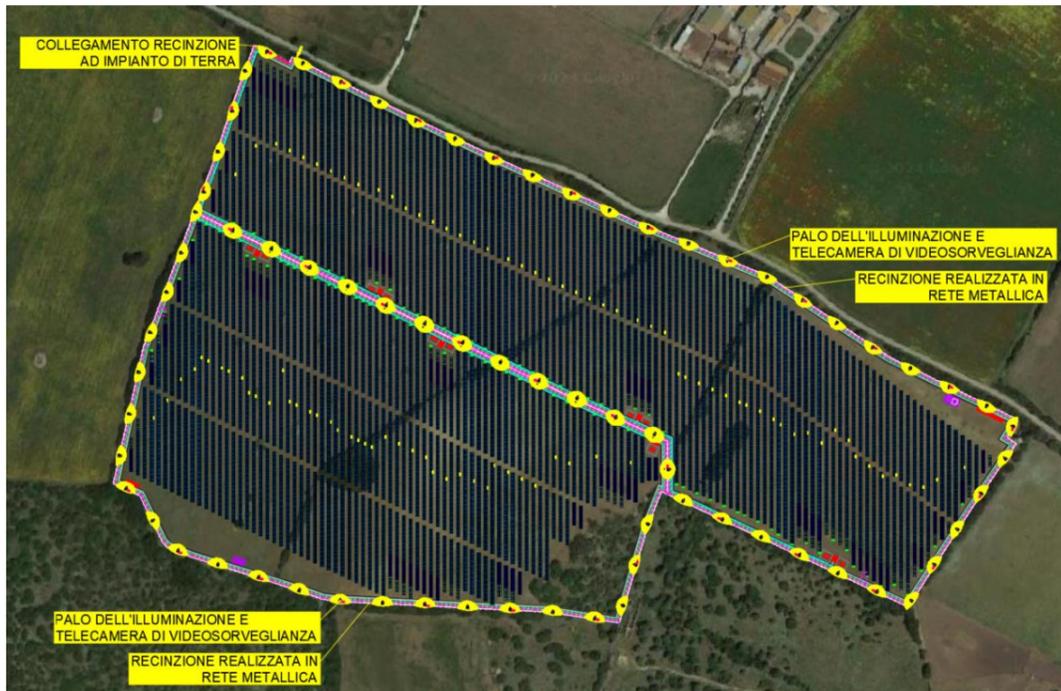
Planimetria illuminazione e videosorveglianza impianti Truncu Reale 6 e 7
